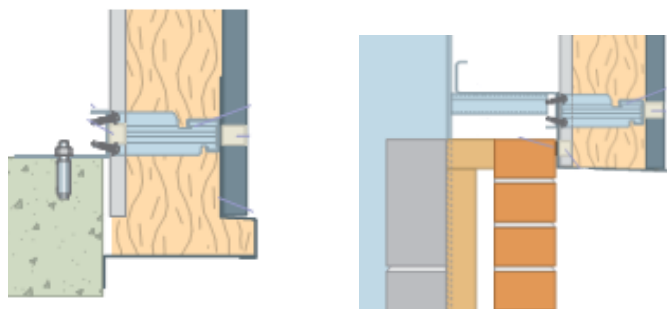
Remate de base de fachada da solução AS Twin skin wall system [90].
